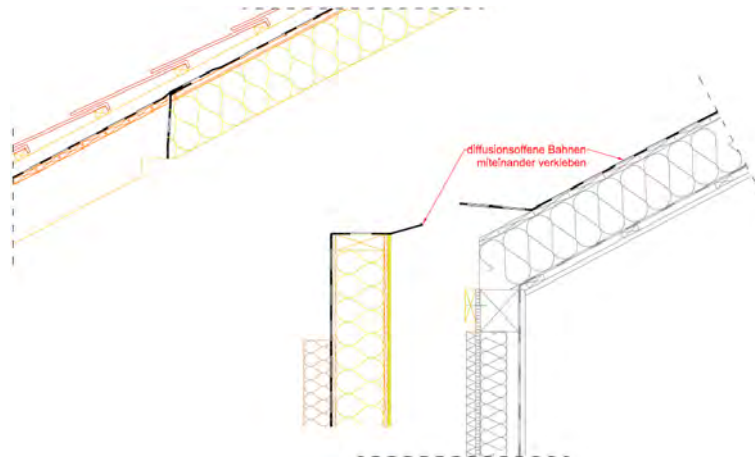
Montagedetail Traufe mit ausgebautem DG
